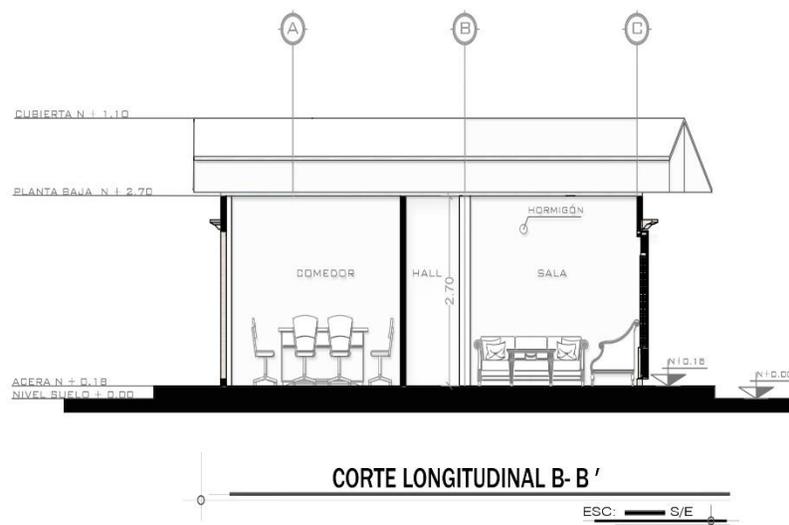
Sección transversal A-ANota. Elaborada por autores. (2021)*Figura 65*Sección longitudinal B-B'Nota. Elaborada por autores. (2021)
